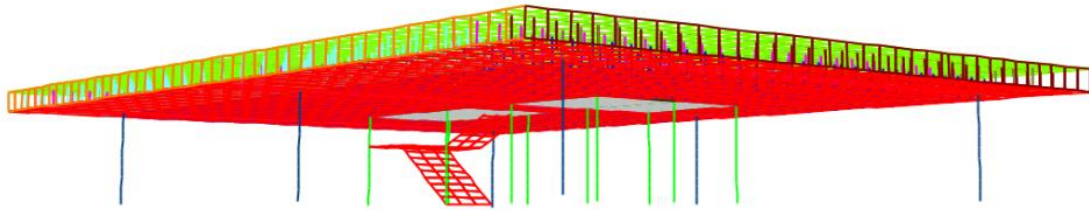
Vista inferior da Laje do 1 Pavimento da Estrutura Com Mesa Inferior
